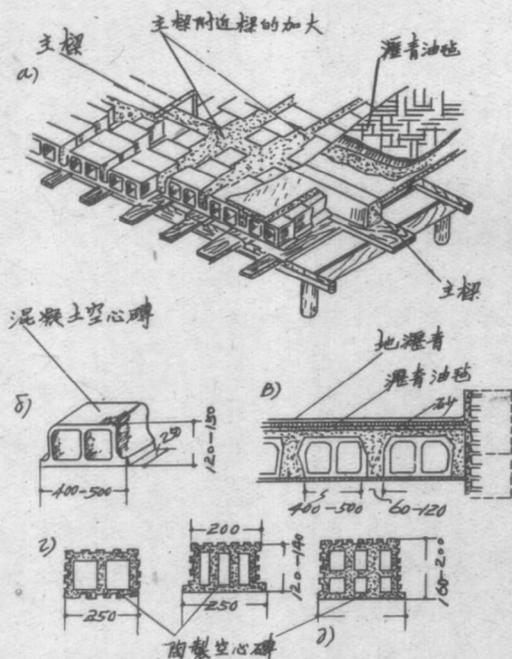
用空心混凝土或陶製填充塊材的密樑現澆筋混凝土樓板層
